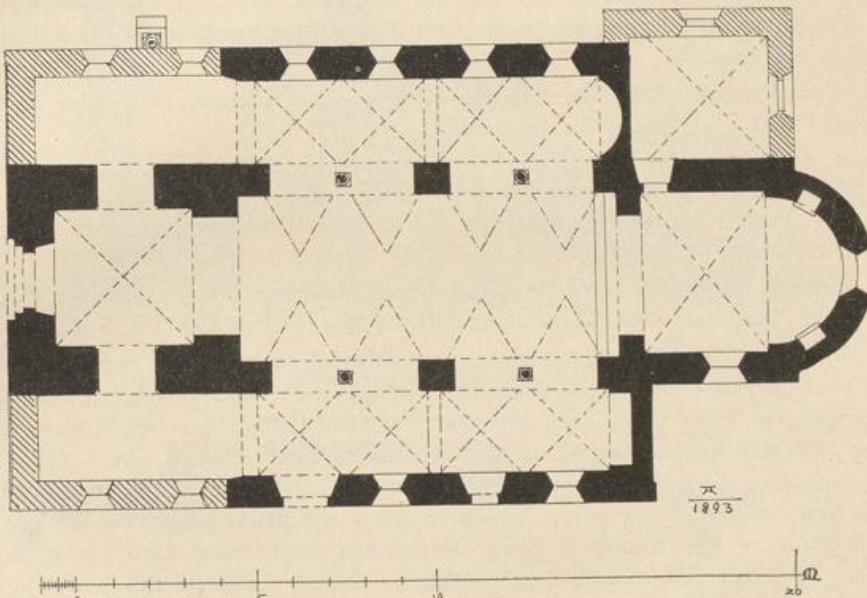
Paffrath. Grundriss der katholischen Pfarrkirche.
